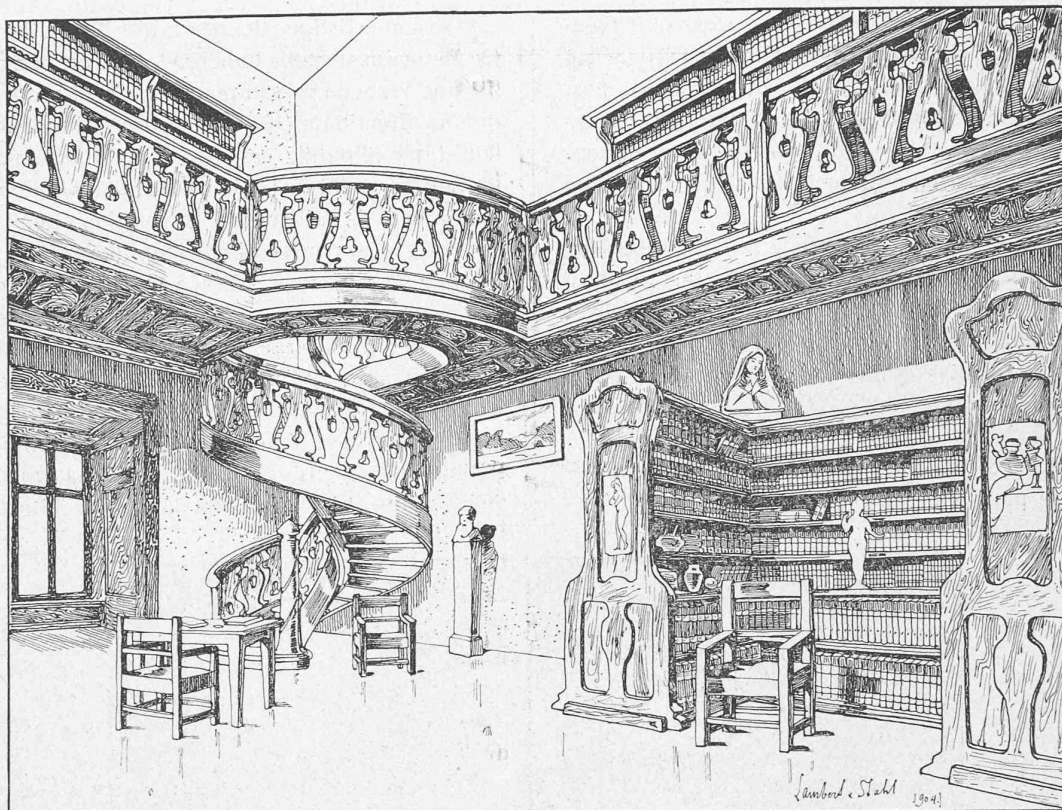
Bibliothèque d'un château. — Architecte : MM. Lambert & Stahl, à Stuttgart.
